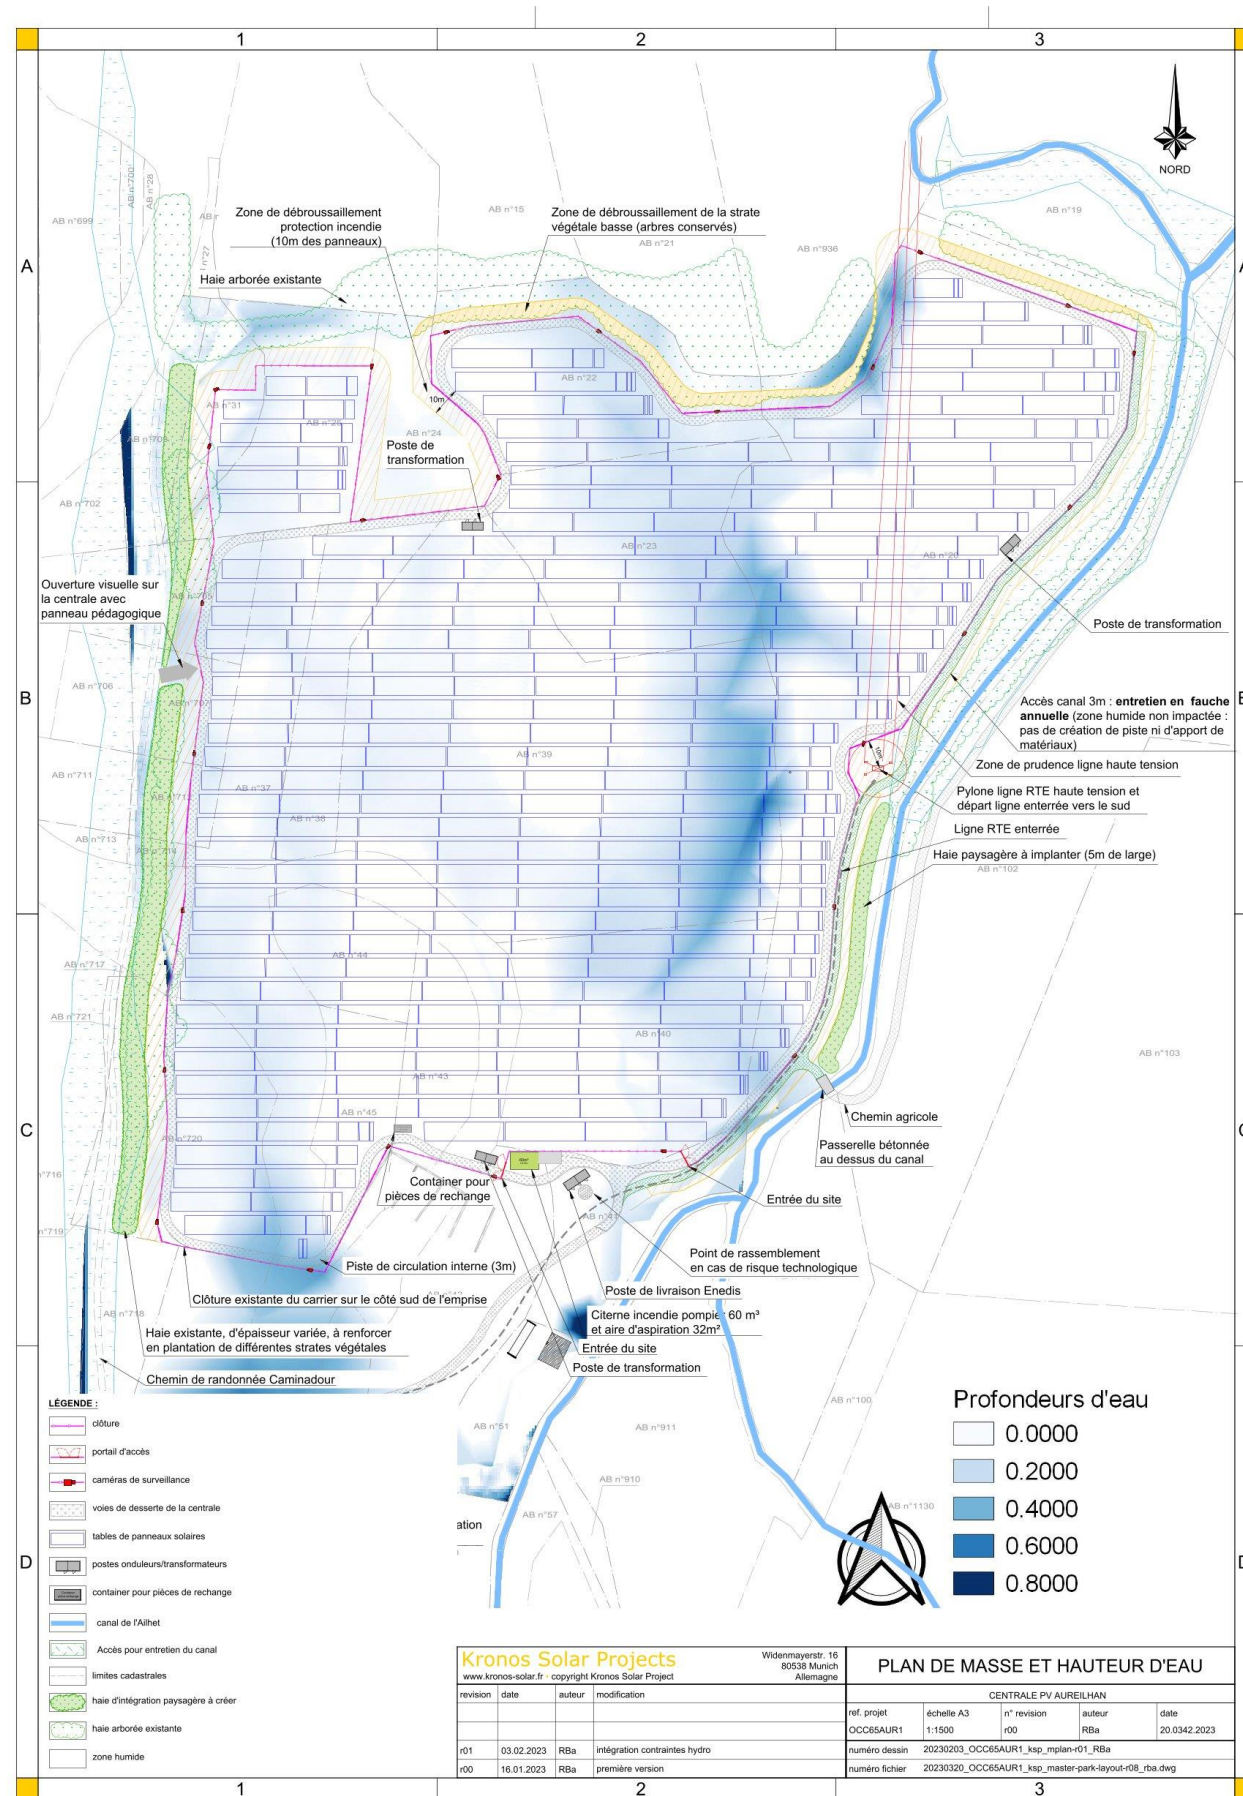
Plan masse sur et hauteur d'eau en crue centennale de l'Adour (Source : Porteur de projet)
